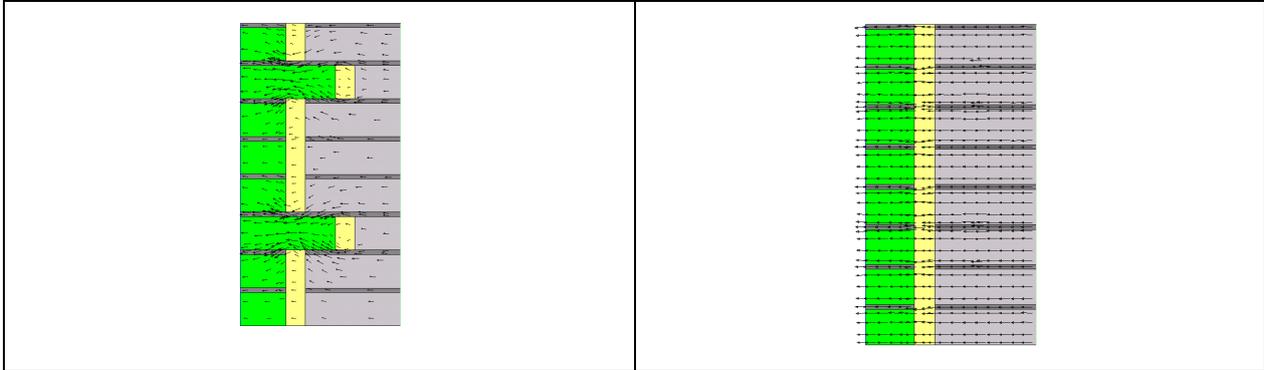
Невентилируемая утепленная кирпичная стена с прокладными рядами кирпичей (слева) и со стальными узлами.
